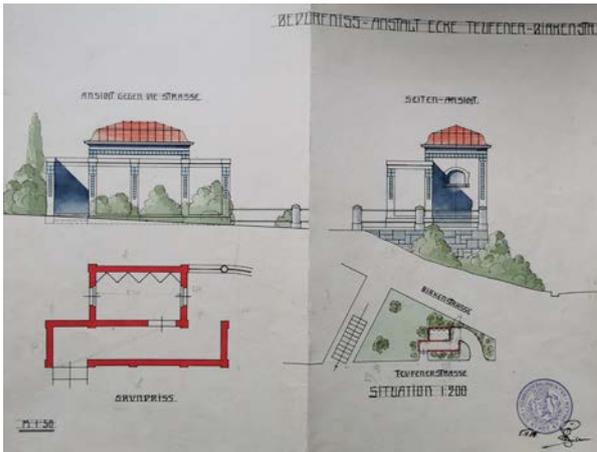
Ansicht und Grundriss einer Bedürfnisanstalt an der Ecke Teufener Strasse / Birkenstrasse, Albert Pfeiffer, 1904. Baudok., Archiv Nr. CXII 16.
